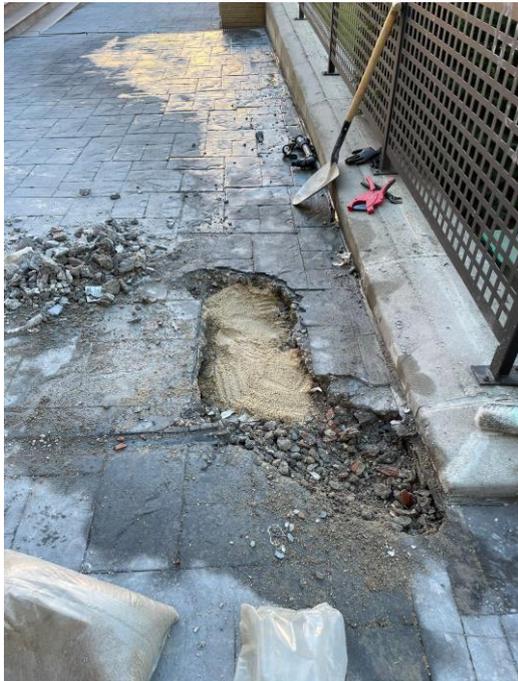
Vista de los trabajos de tapado y hormigonado de la cala.
